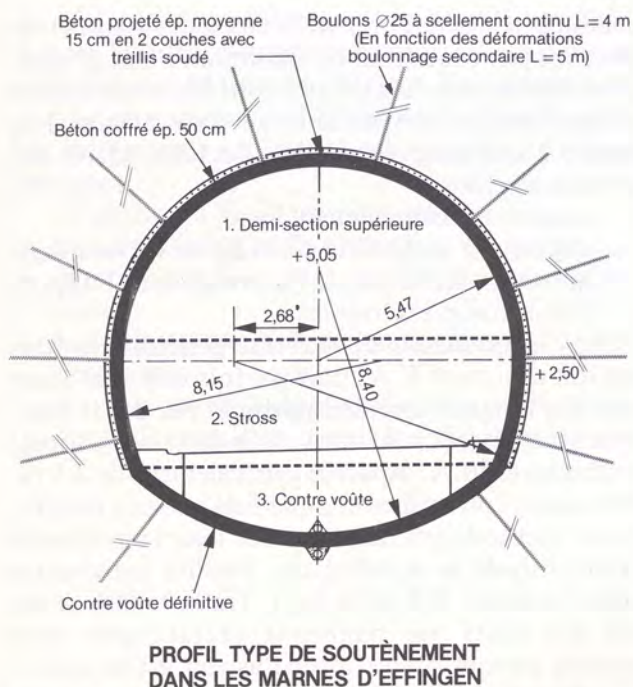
Profil type de soutènement et phasage d'excavation du tunnel de CHAMOISE.
